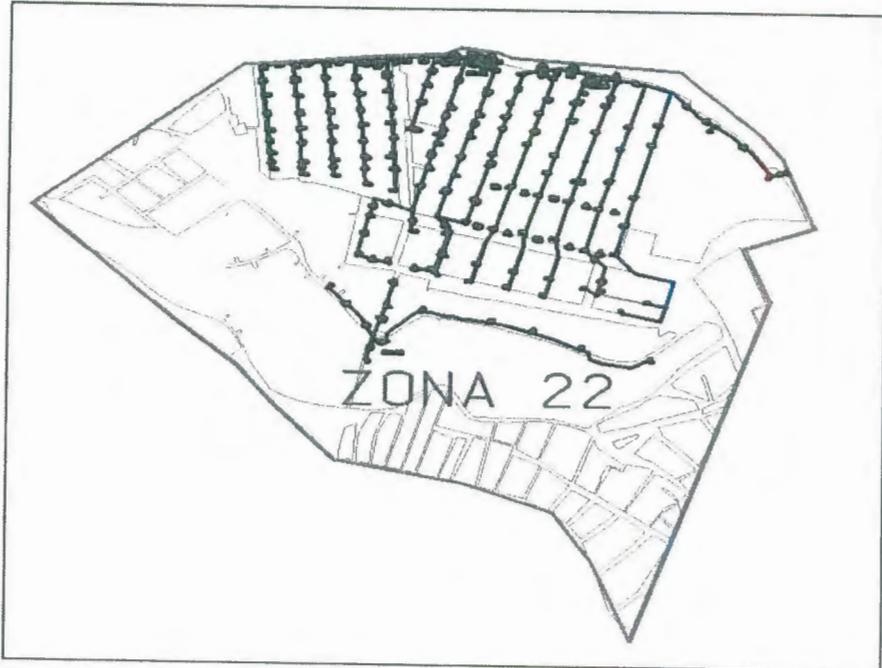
Planimetría zona 22 del sector de la vía a Daule
